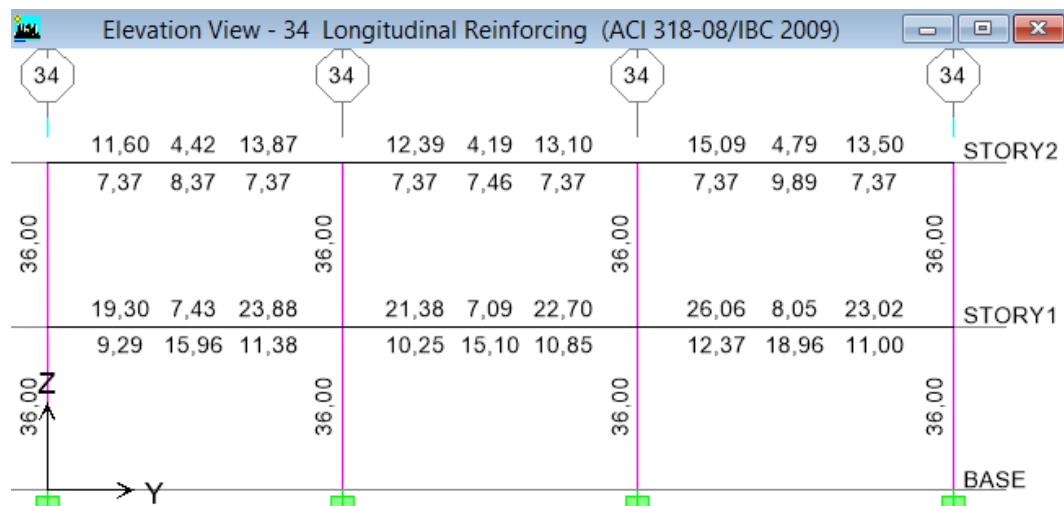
Acero en Vigas y Columnas en el Pórtico 34 – C. Quirúrgico- (CEC2002)
